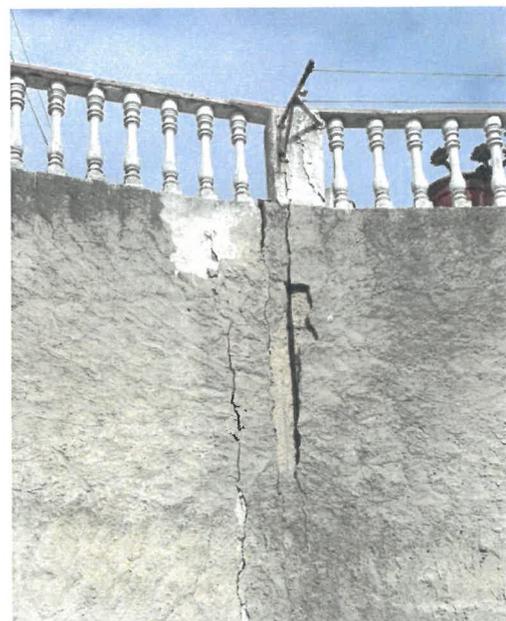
Vista do muro a Sudeste da propriedade
